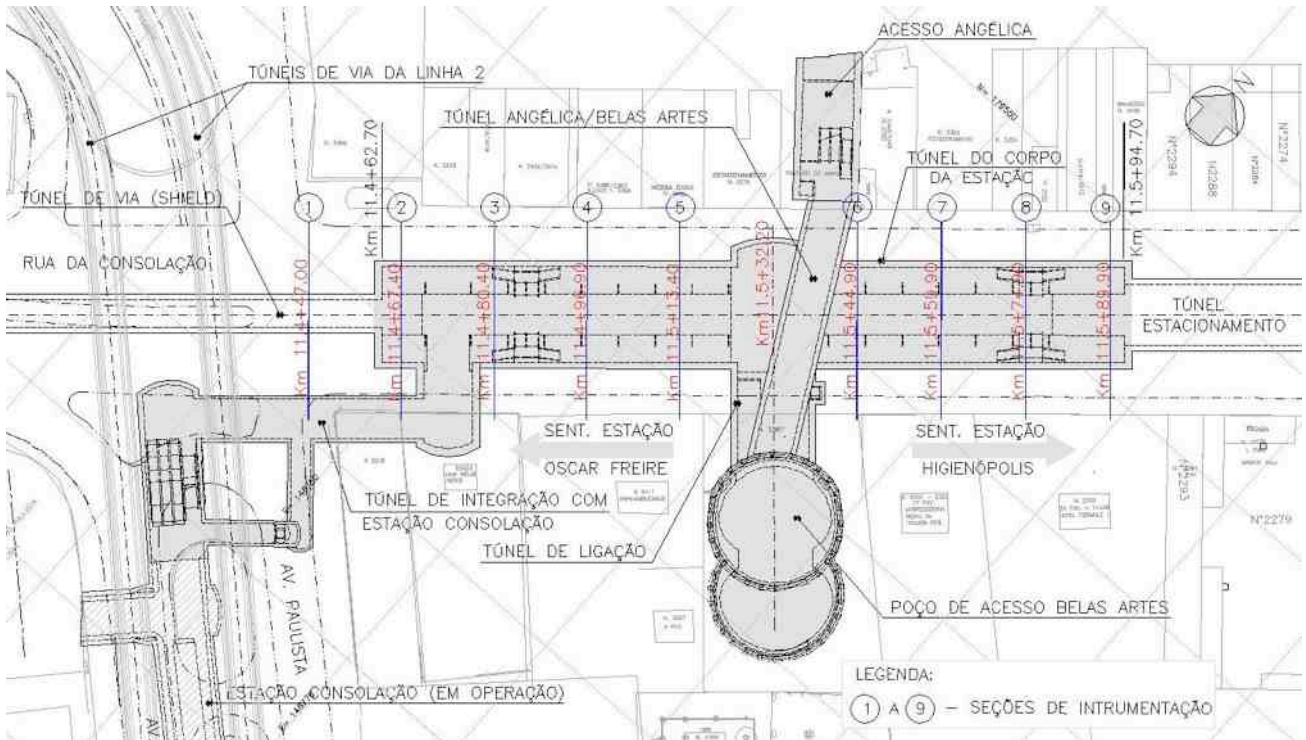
Planta da Estação Paulista da Linha 4 do Metrô de São Paulo.
